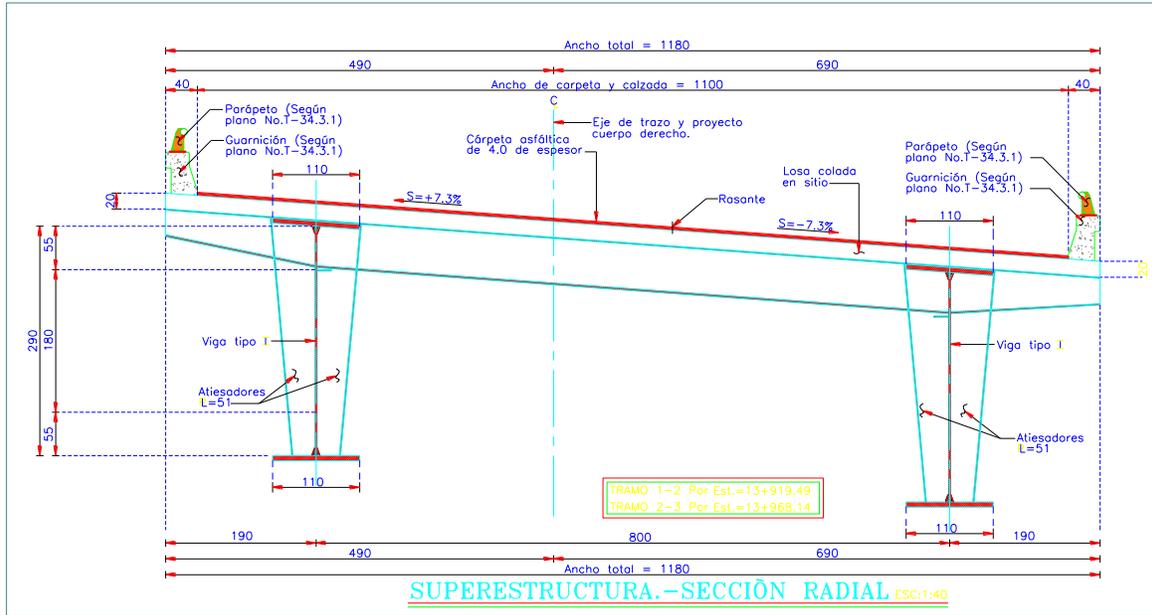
Sección transversal – Cuerpo izquierdo – Viaducto Las Canteras I
